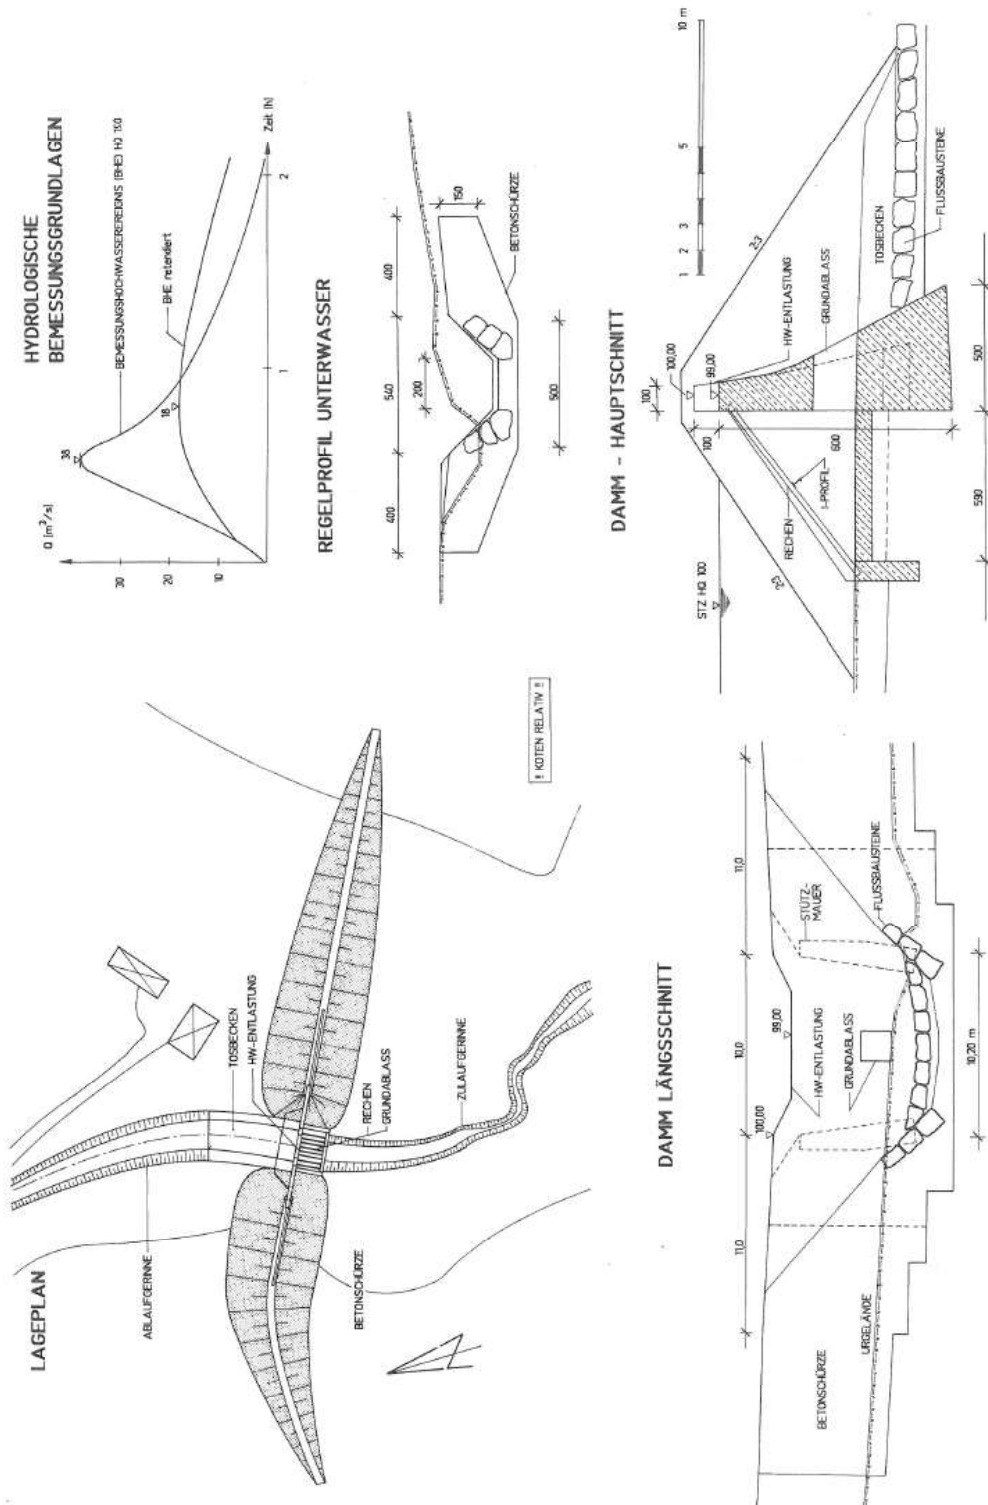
Lageplan und Schnitte, HRB Hunnesbach
